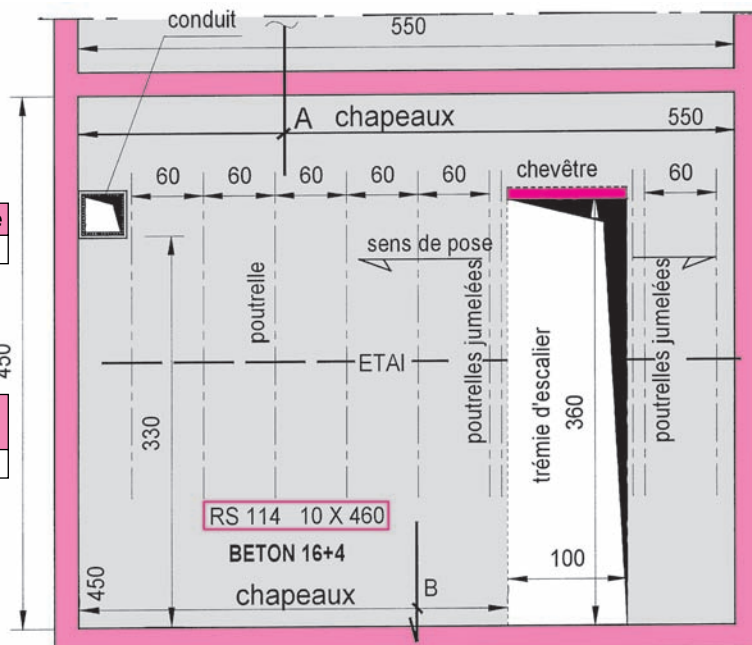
Extrait d'un plan de pose d'un plancher à poutrelles
